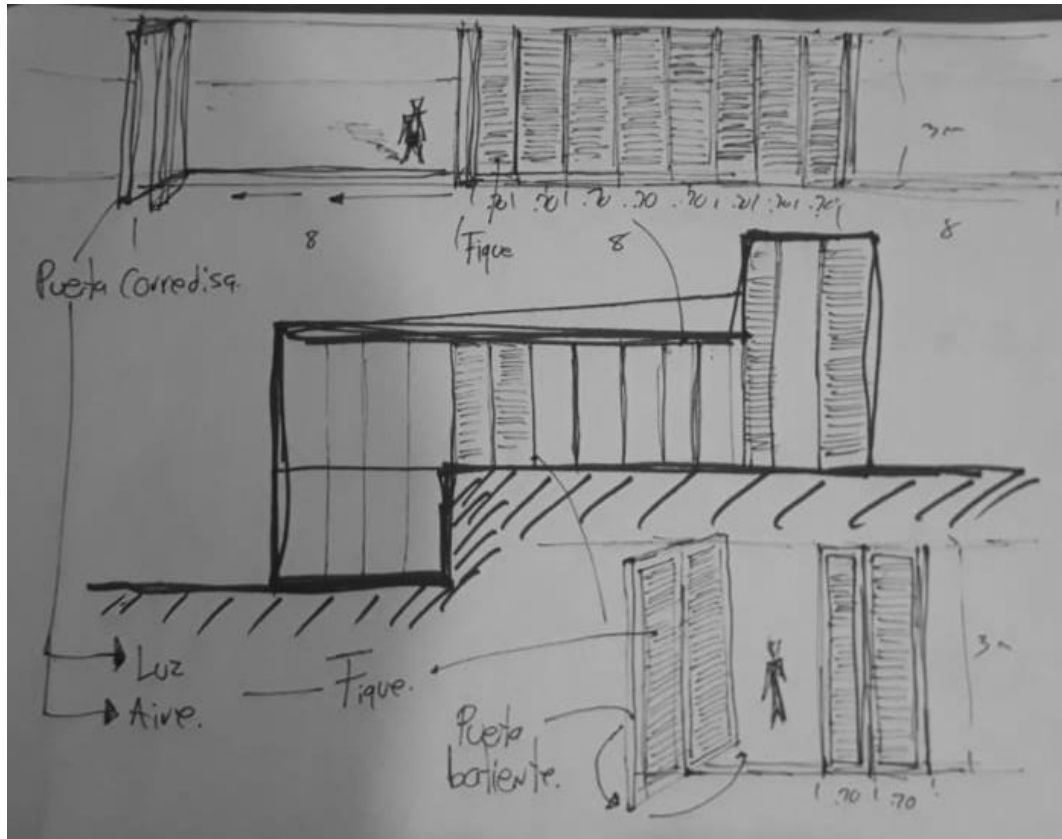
Boceto a mano alzada propuesta de fachada para el teatro municipal.
